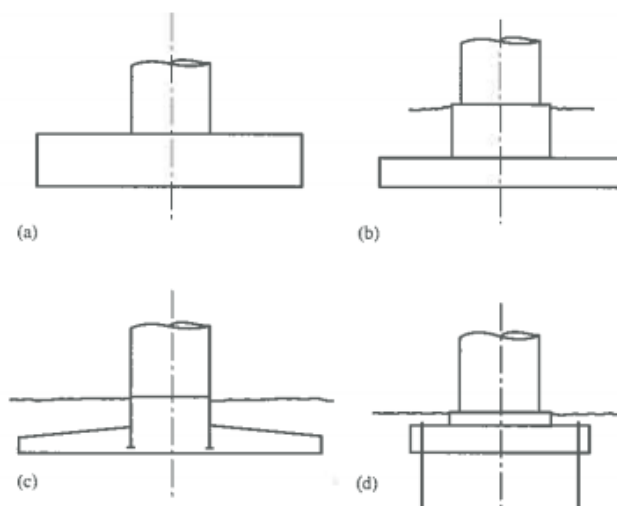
Tipos de fundações em laje: a) laje plana; b) fundação em pedestal; c) laje cônica; d) laje ancorada [4]
